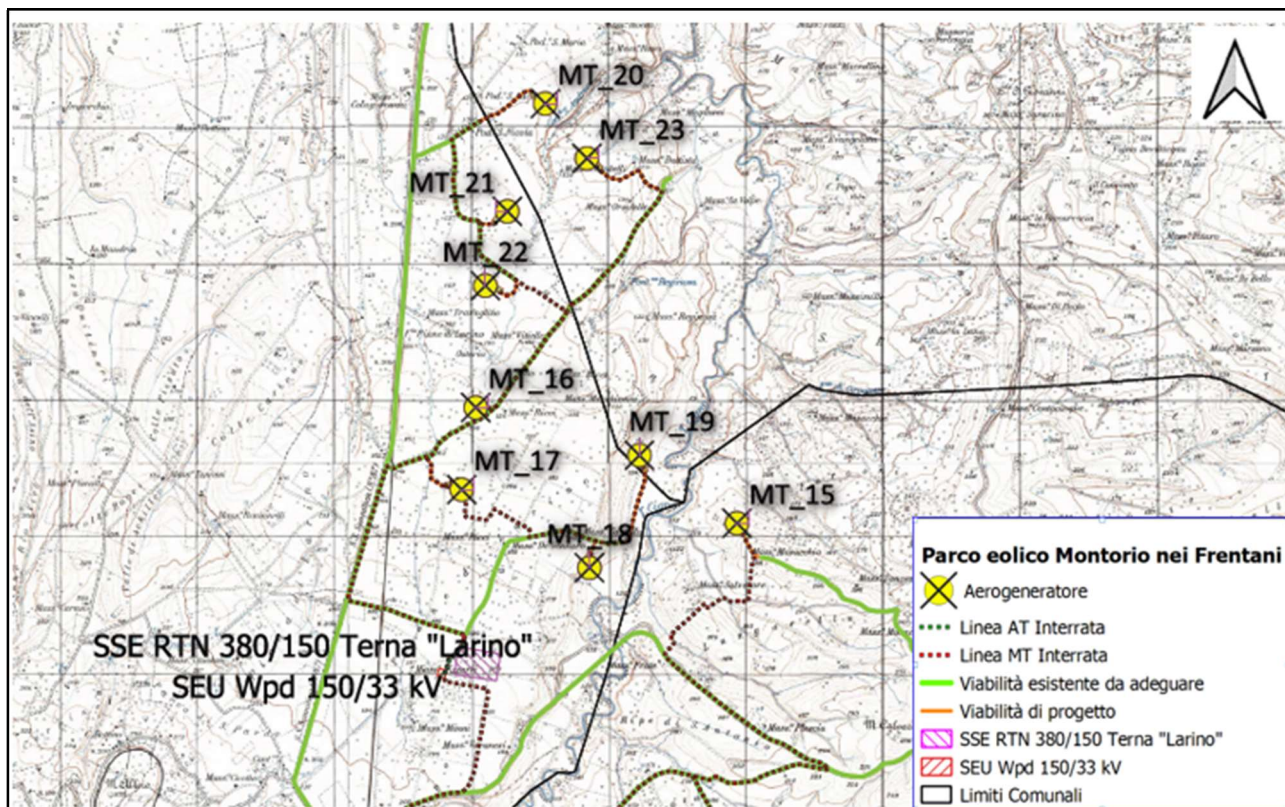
Layout d’impianto: Zona 1 su IgM
